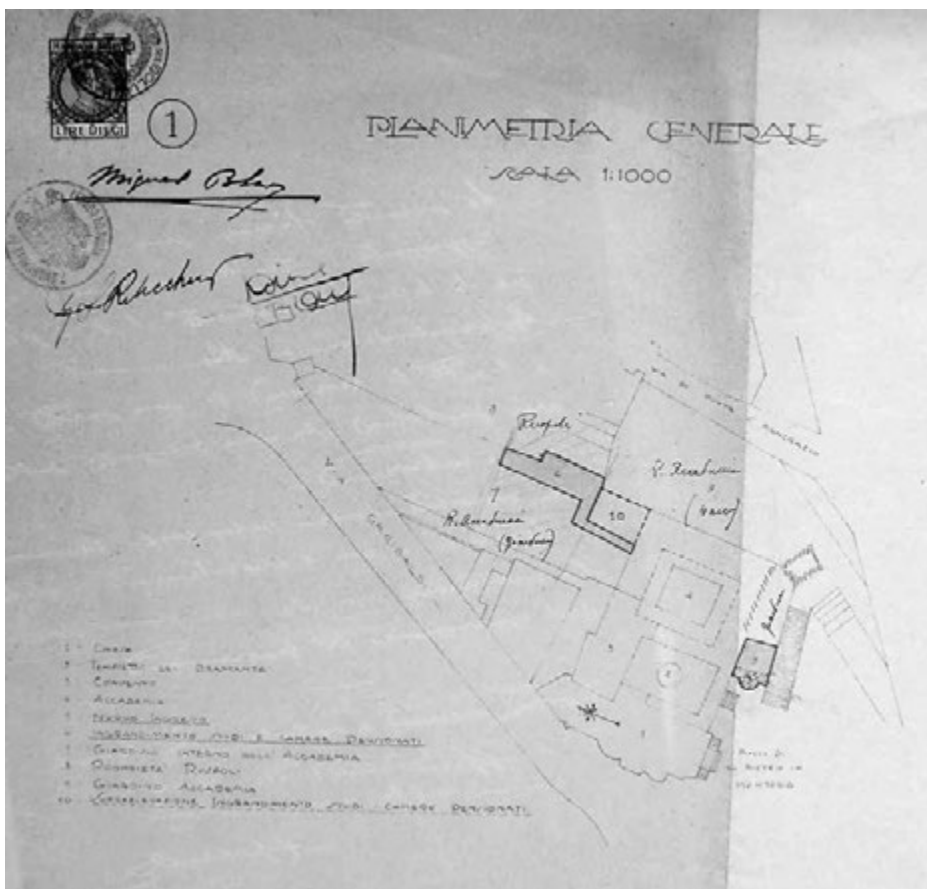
Salvatore Rebecchini e Jaime Blay, ristrutturazione dell'Accademia, planimetria generale con localizzazione degli interventi, 1929, ASC, *Ispettorato edilizio*, prot. 14711, anno 1929
